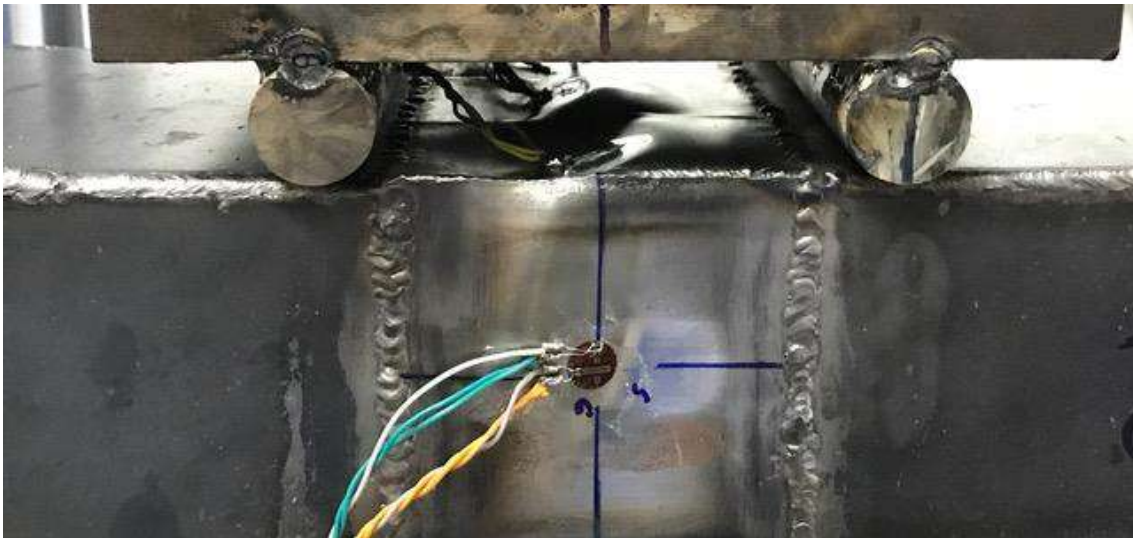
Falha da viga-caixão durante o teste de flexão
